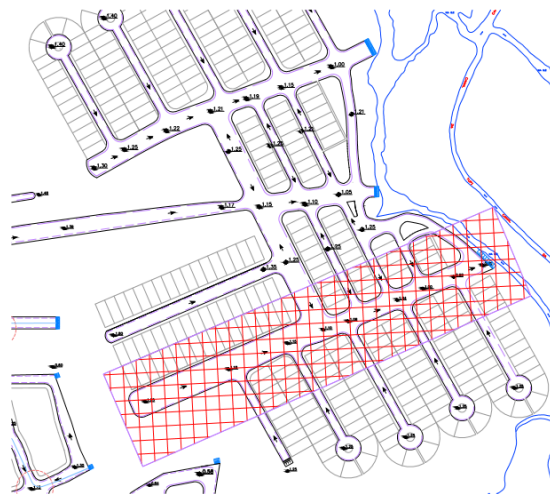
Sub-Bacia 03, trecho mais solicitado Fonte: Planta autoral Autocad.
